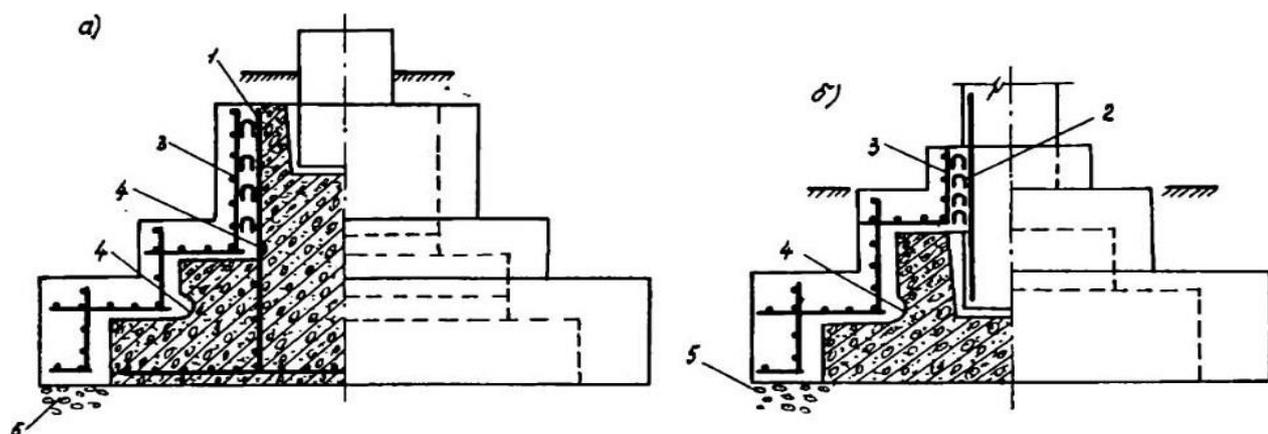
Схема усиления фундамента под колонну с помощью железобетонной обоймы (а – при наличии развитого подколонника с достаточно мощной продольной аматурой; б - при отсутствии развитого подколонника): 1 – арматура подколонника; 2 – арматура колонны; 3 – арматура обойм; 4 – борозды в теле фундамента; 5 – уплотненный щебнем грунт.
